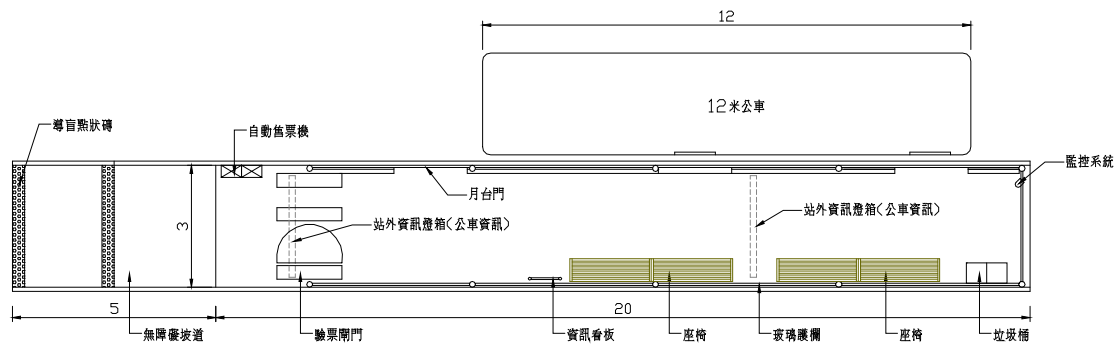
BRT 車站站體(3 公尺寬)平面配置示意圖
